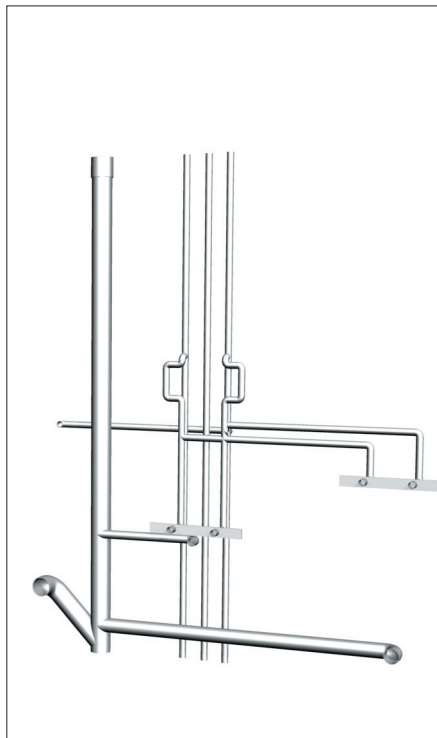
Rohrleitungsbündel fassen vorgefertigte horizontale und vertikale Rohrleitungsteile zu einem montagefertigen Element zusammen. Die Rohrleitungsbündel besitzen bereits alle Verbindungselemente und Anschlussmöglichkeiten für Sanitärgegenstände und Armaturen. Sie werden meist frei vor der Wand montiert und benötigen noch eine entsprechende Tragkonstruktion und Verkleidung. Sie werden speziell für einen Einsatzort gefertigt. Ihr Vorfertigungsgrad ist im Vergleich zu Rohrleitungsteilen höher.
